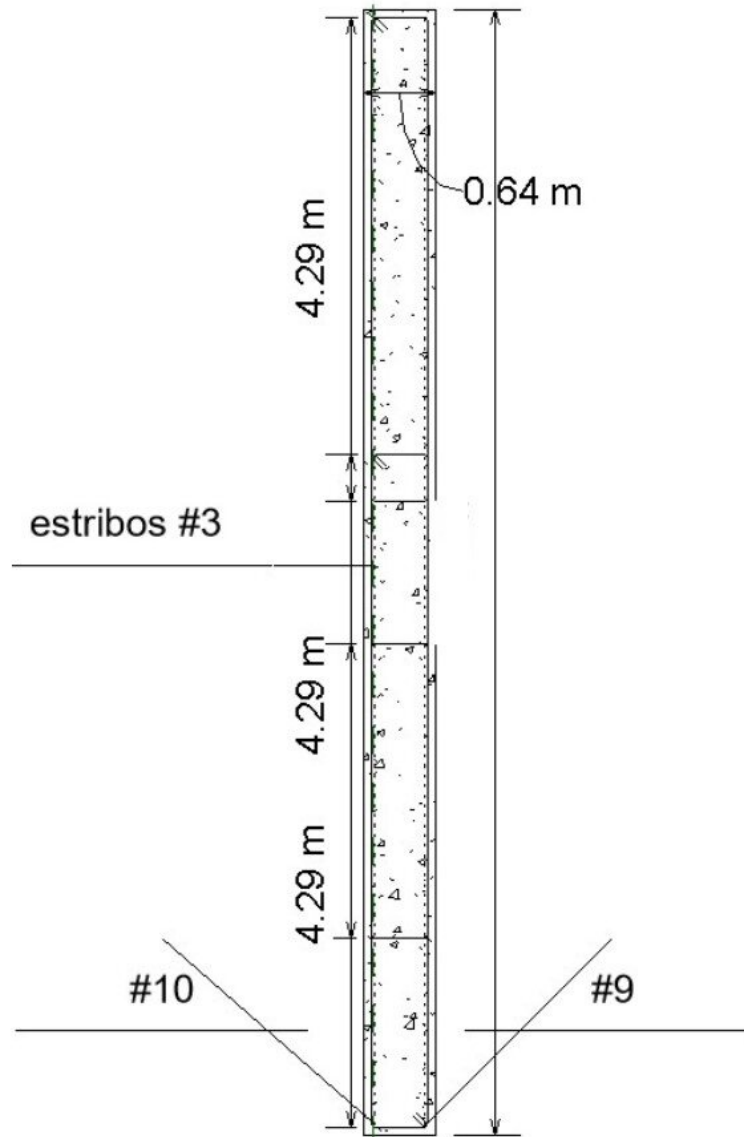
Detalle del refuerzo longitudinal del muro de la alcantarilla de una celda.
